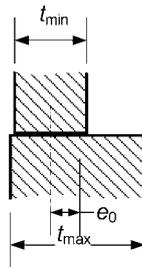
Planmäßiger Absatz e_0 in einer Schale mit Stumpfstoß
